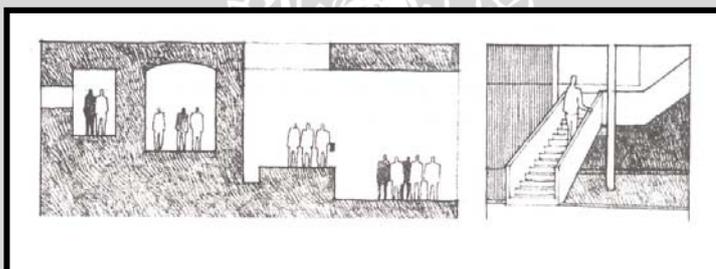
Jalan Masuk ke dalam Bangunan
